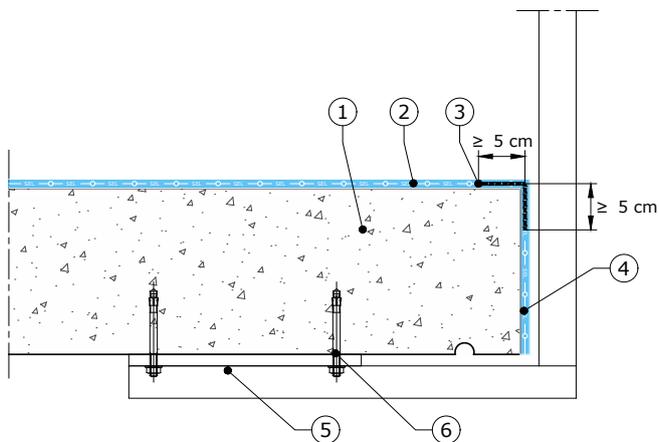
Garde-corps avec fixation sous dalle - Exemple
